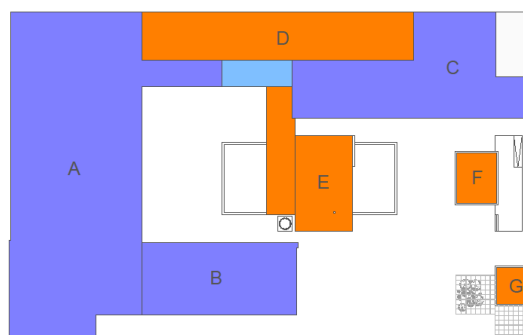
Esquema do Conjunto pré-existente e integração de novas construções e equipamentos
